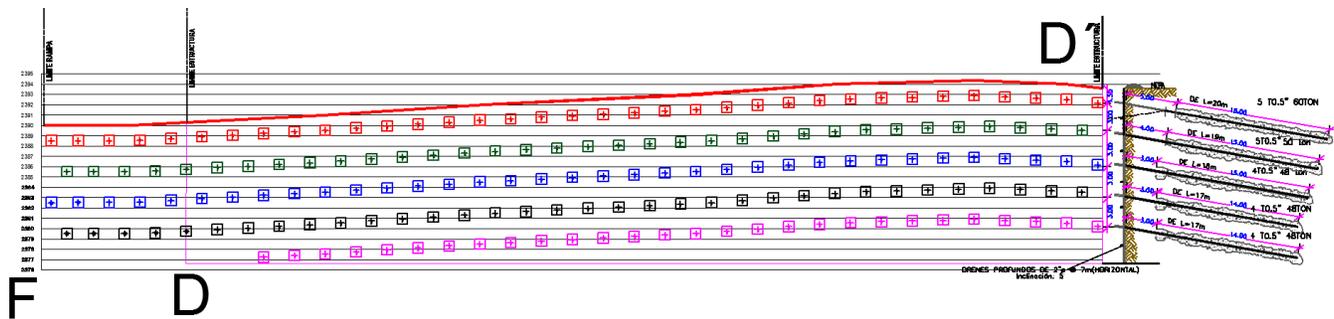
CORTE D-D', SISTEMA DE ANCLAJE
